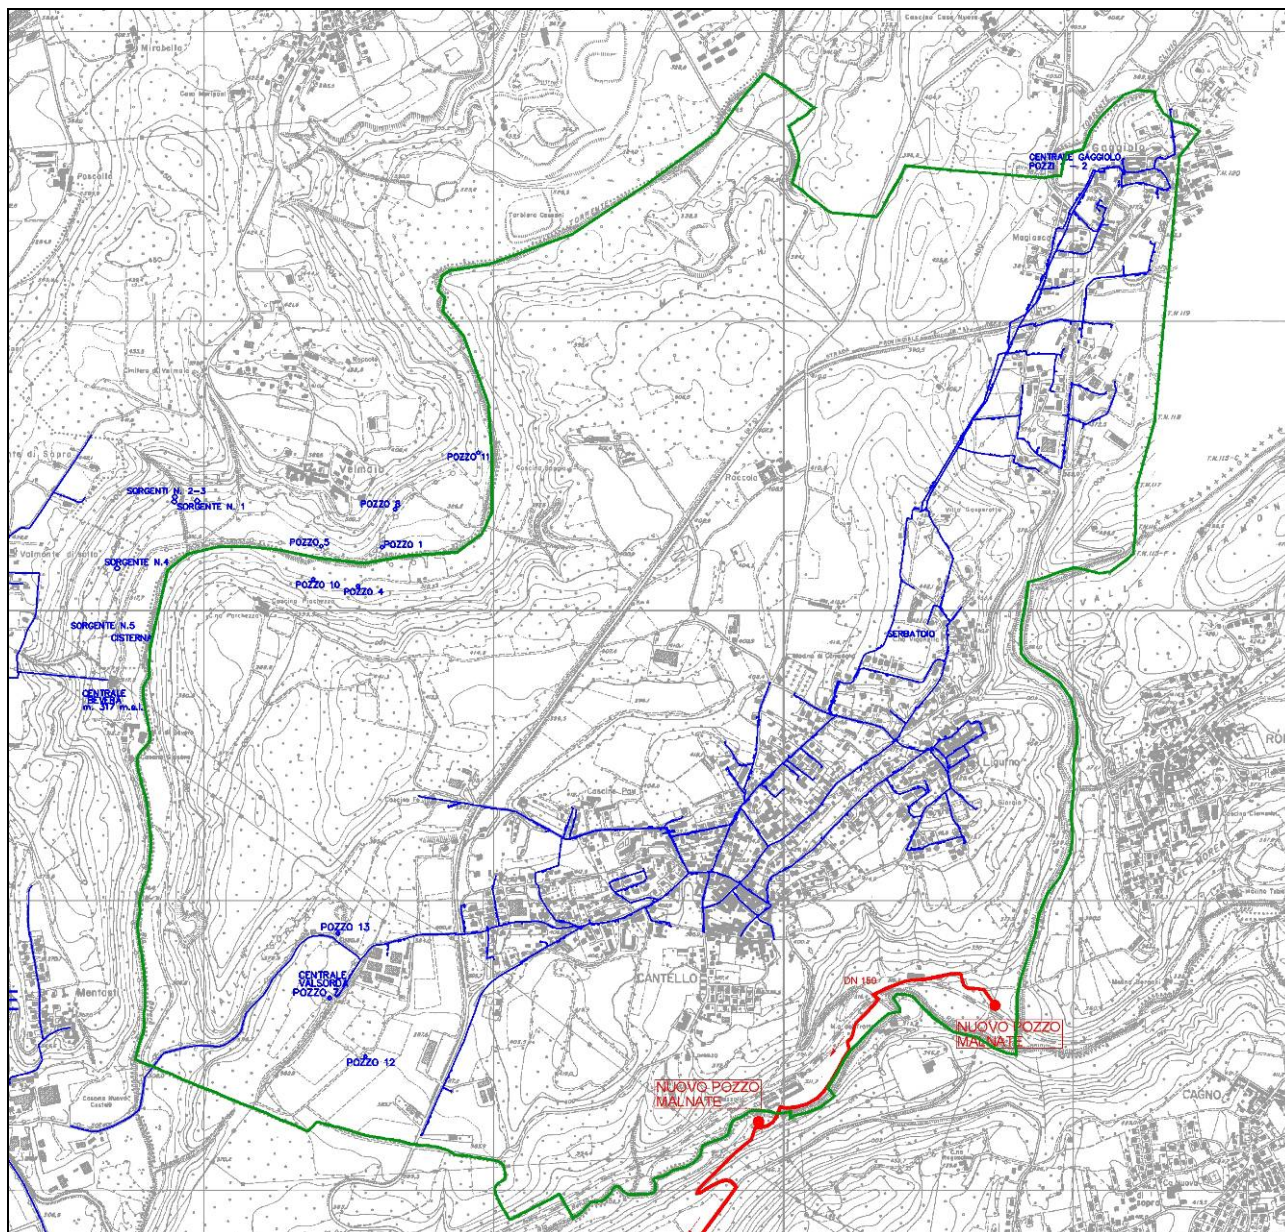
Figura A: Planimetria della rete distributiva dell'acquedotto di Cantello
